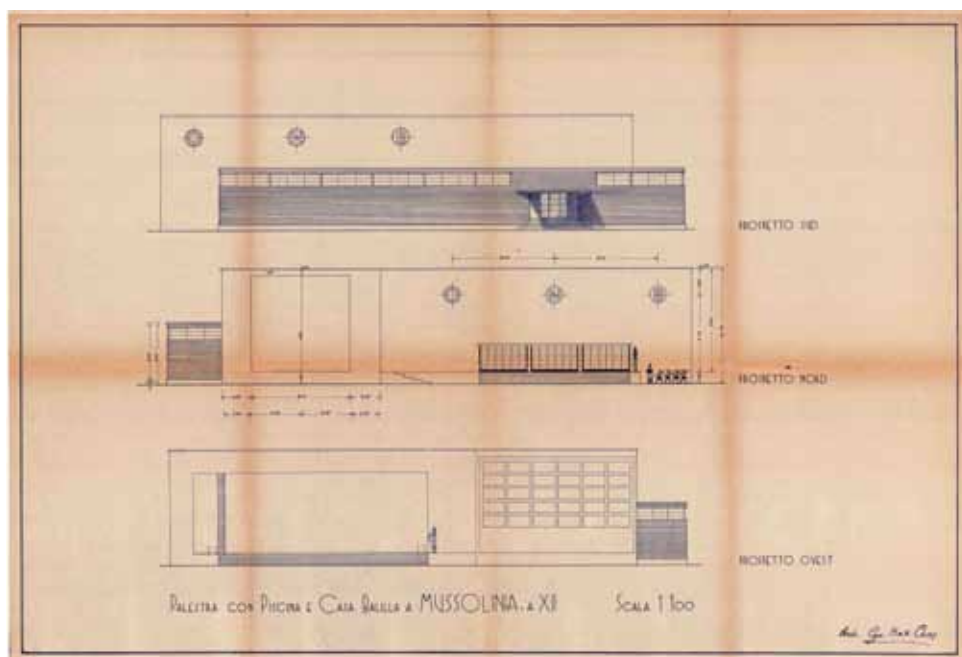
Progetto di Palestra con Piscina e Casa Balilla. Arch. G.B. Ceas. Pianta e sezioni. ASBS.
